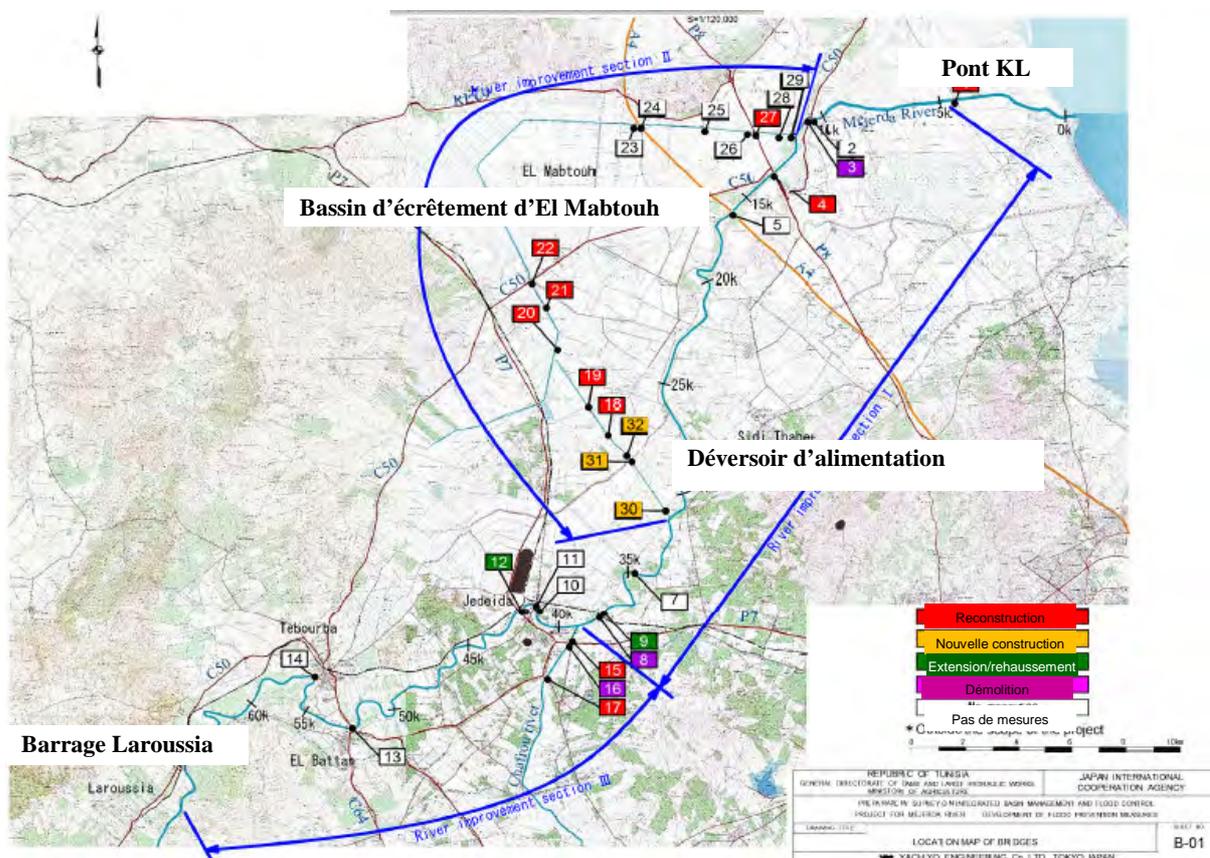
Zone de mise en œuvre du projet d'amélioration de l'oued et du projet du bassin de retardement (sections des travaux et emplacement des ponts et ouvrages de franchissement)
